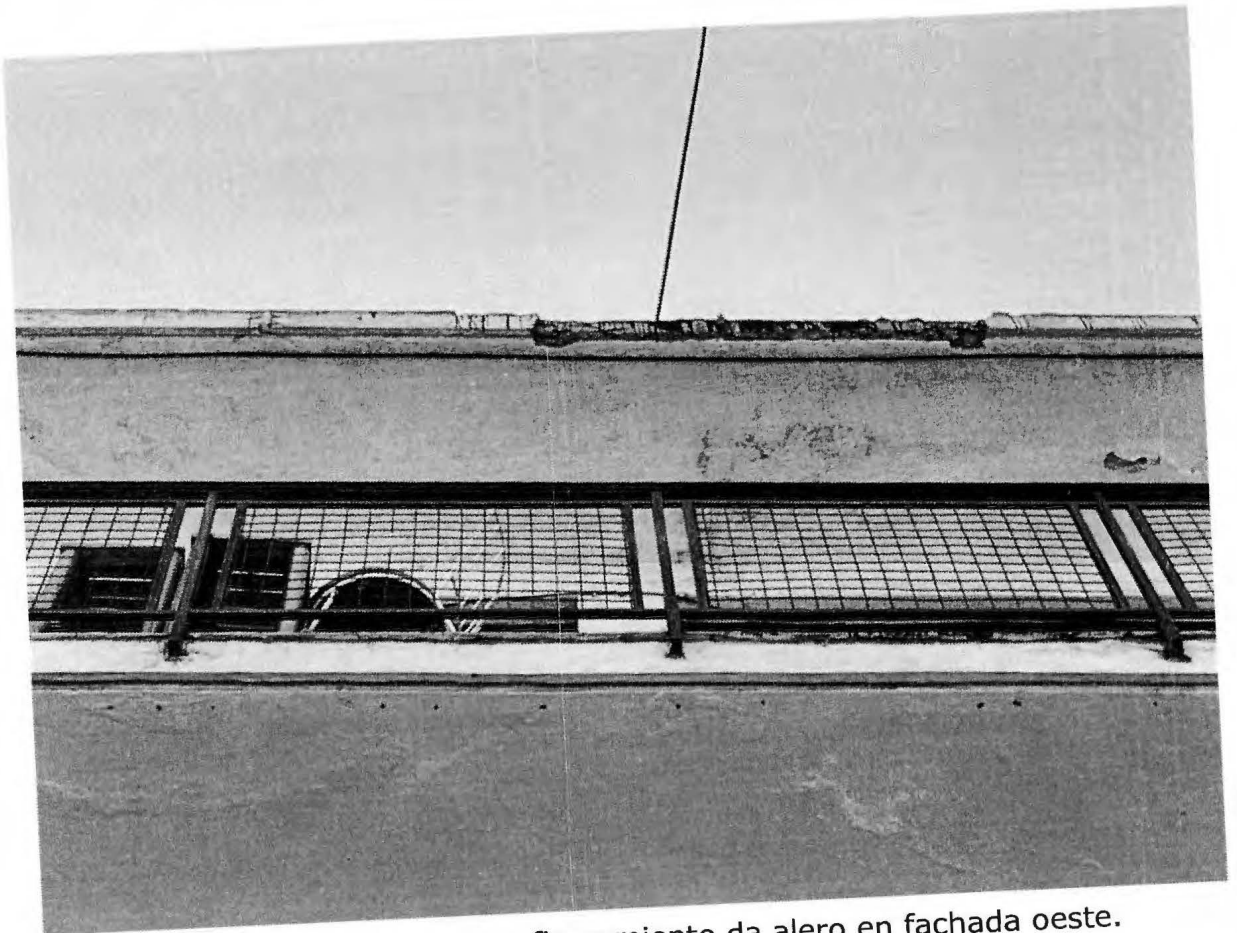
Desprendimiento y fisuramiento da alero en fachada oeste.
